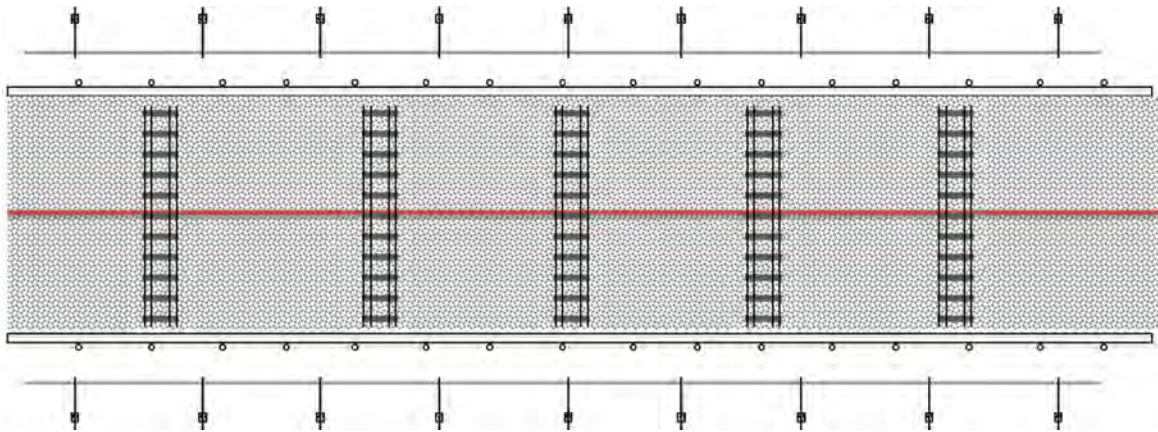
13 Elaboración de tendido de líneas guía y colocación de canastillas con pasa juntas.
